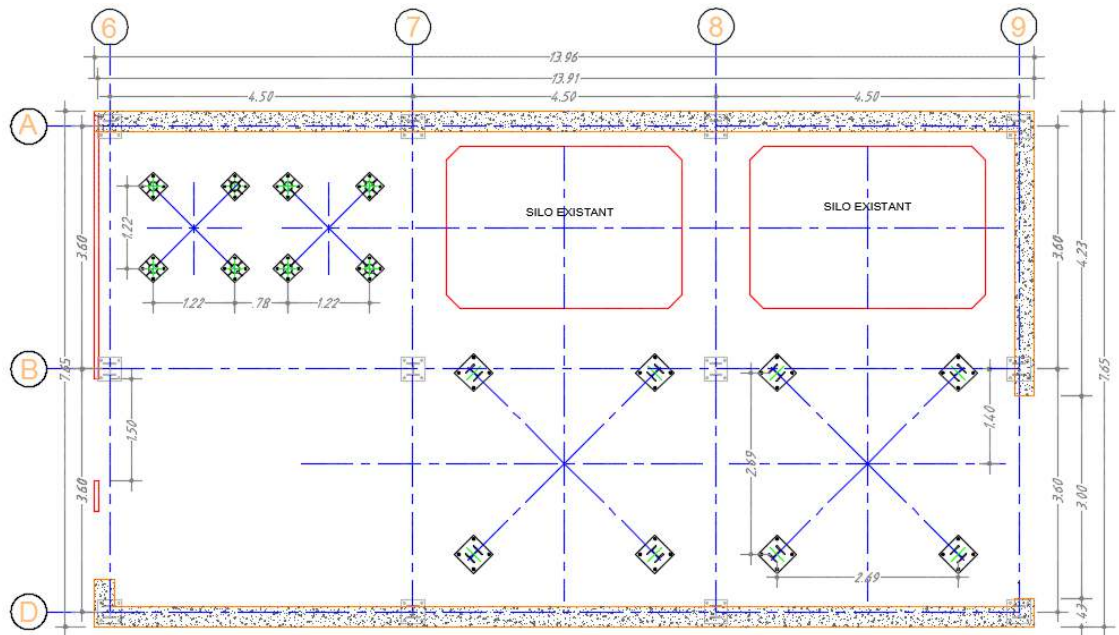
Vue en plan du Plancher Niveau ±0.00
